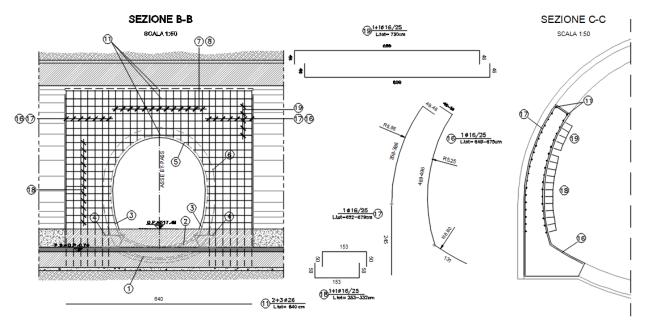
Amatura prevista all'innesto del bypass con le gallerie naturali [15]
